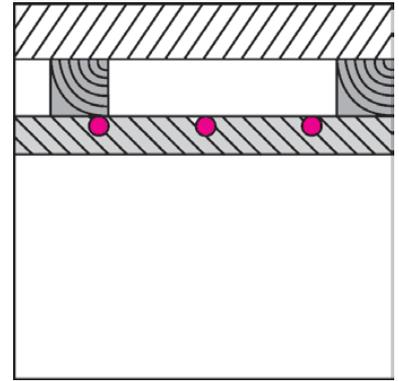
ND1 – Rohrsystem in Trockenbau-Platte – Decke
